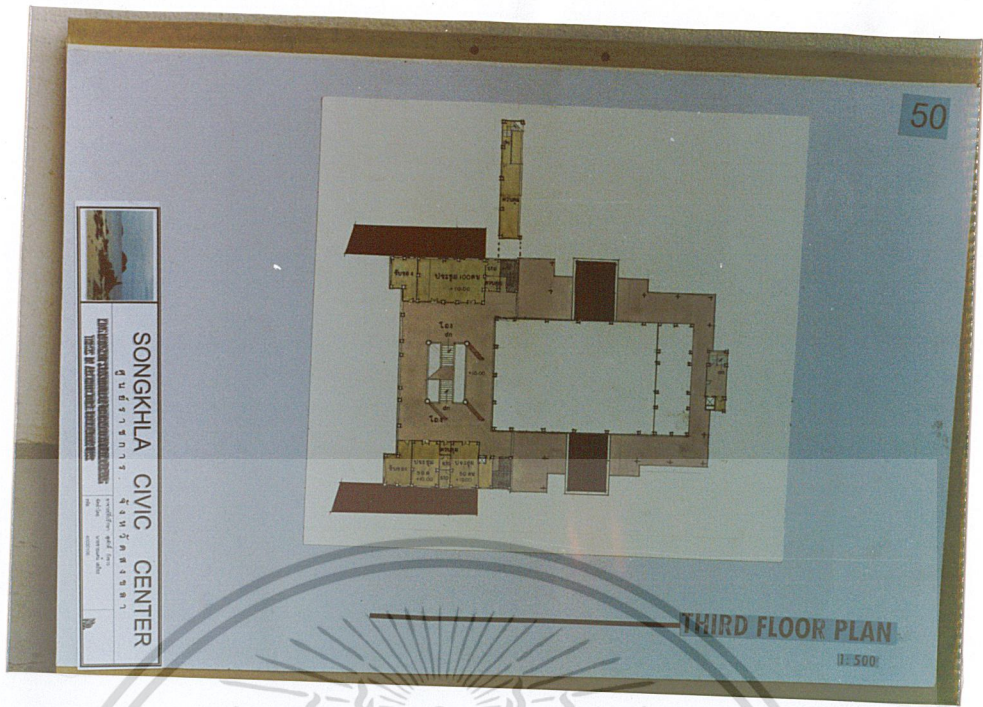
แสดง THIRD FLOOR PLAN
